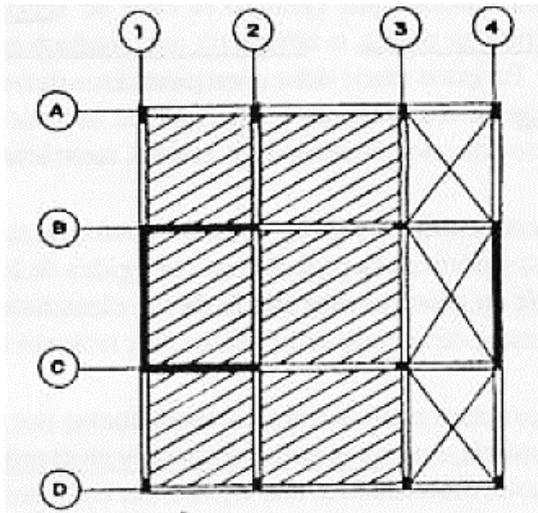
, Planta de edificio con aparente simetría, pero que al tener la abertura en la zona derecha no podrá transferir la fuerza sísmica hacia el eje 4.
